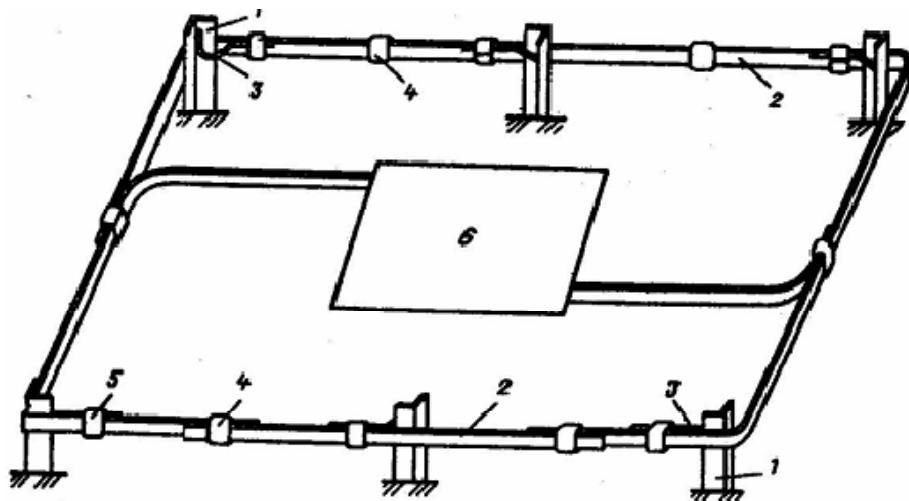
Общий вид заземляющего контура, выполненного методом термической сварки. 1 – вертикальный заземлитель, 2 – горизонтальный заземлитель, 3 – связь заземлителя с горизонтальным заземлителем, 4 и 5 – усиление в месте сварки, 6 – заземляемый объект.
